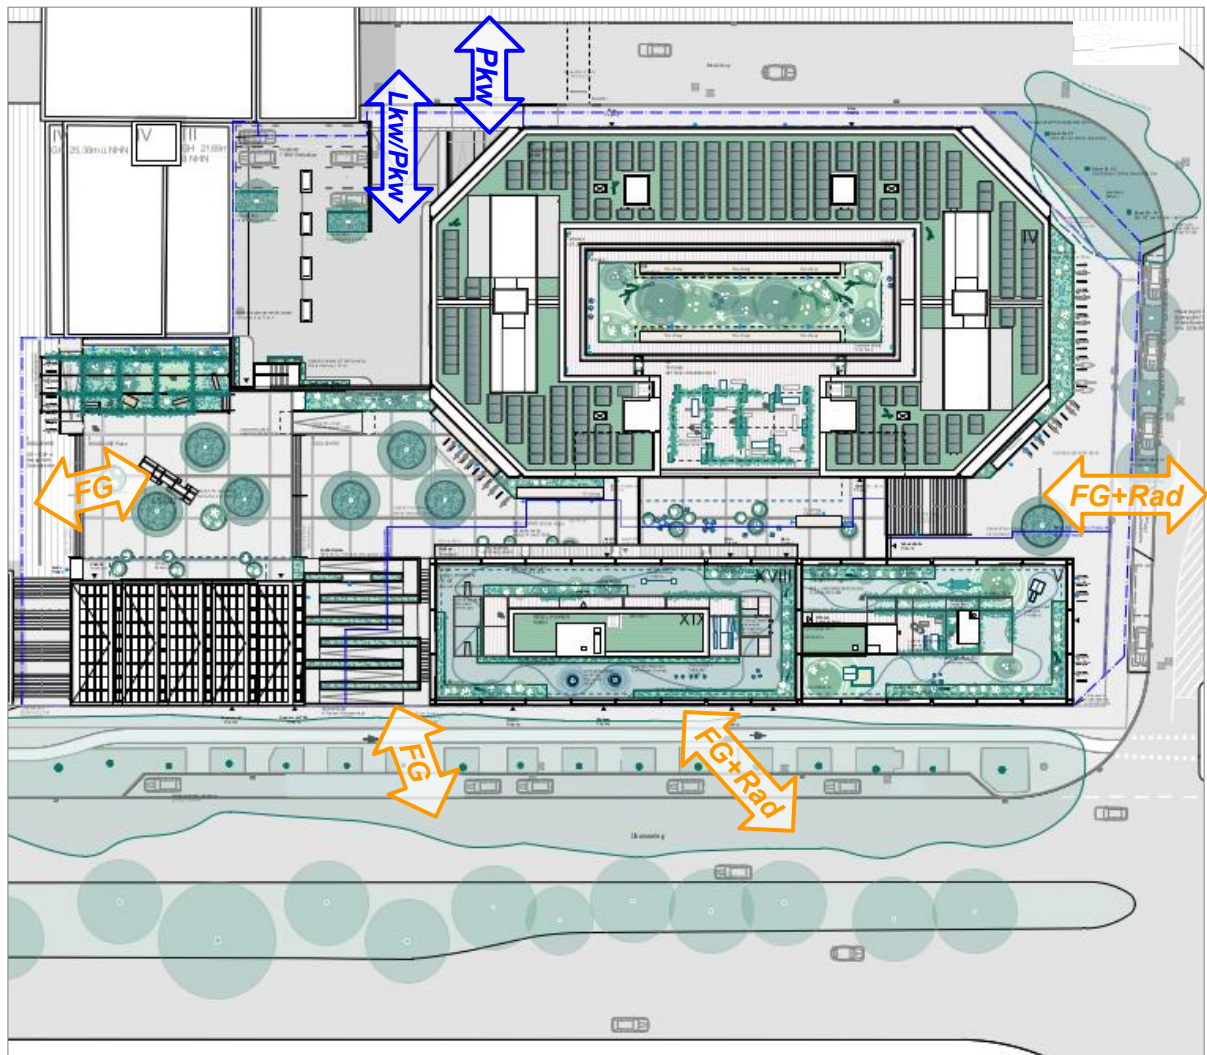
Erschließungskonzept (o.M., Grundlage: Lageplan rabe landschaften, Hamburg [2])
